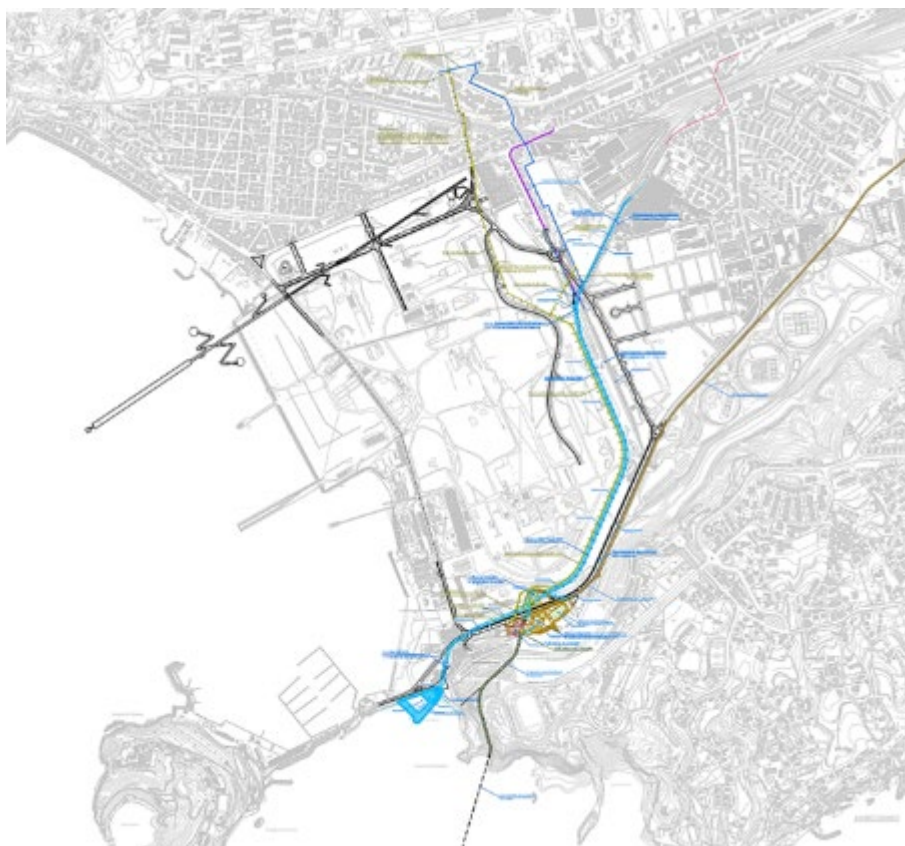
infrastrutture idriche – Generale – Asa e hub idrico – Planimetria generale di progetto
